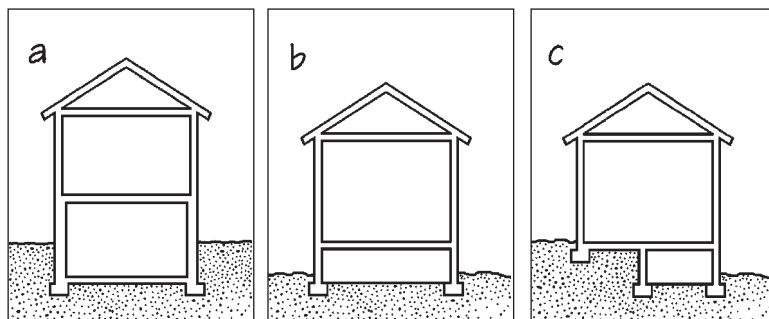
a) fondazione con solaio controterra; b) fondazione con intercapedine; c) fondazione mista
